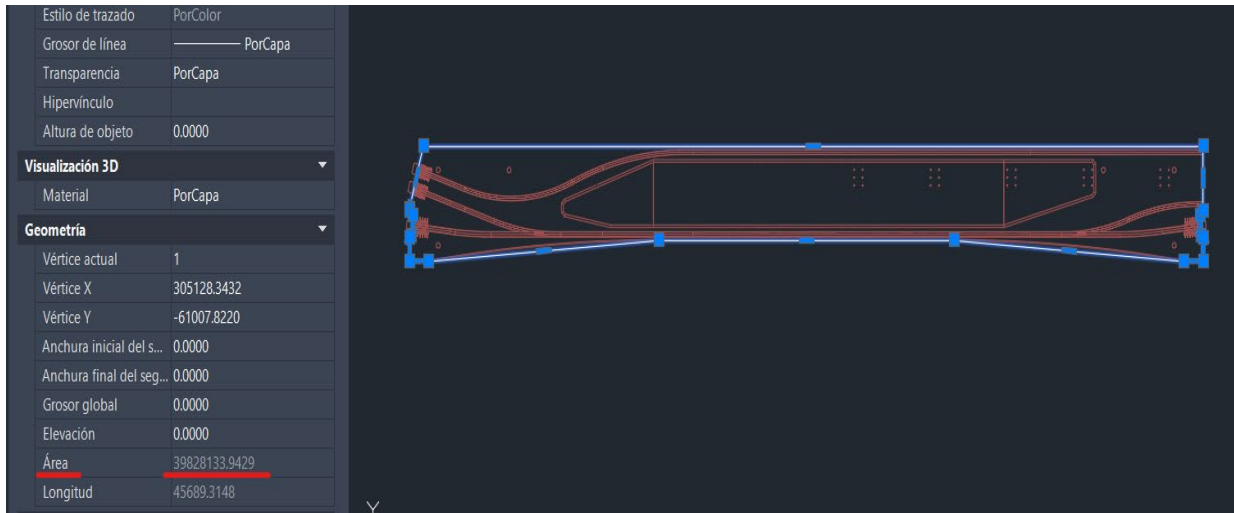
Imagen representativa del área del bloque de viga en AutoCAD.
